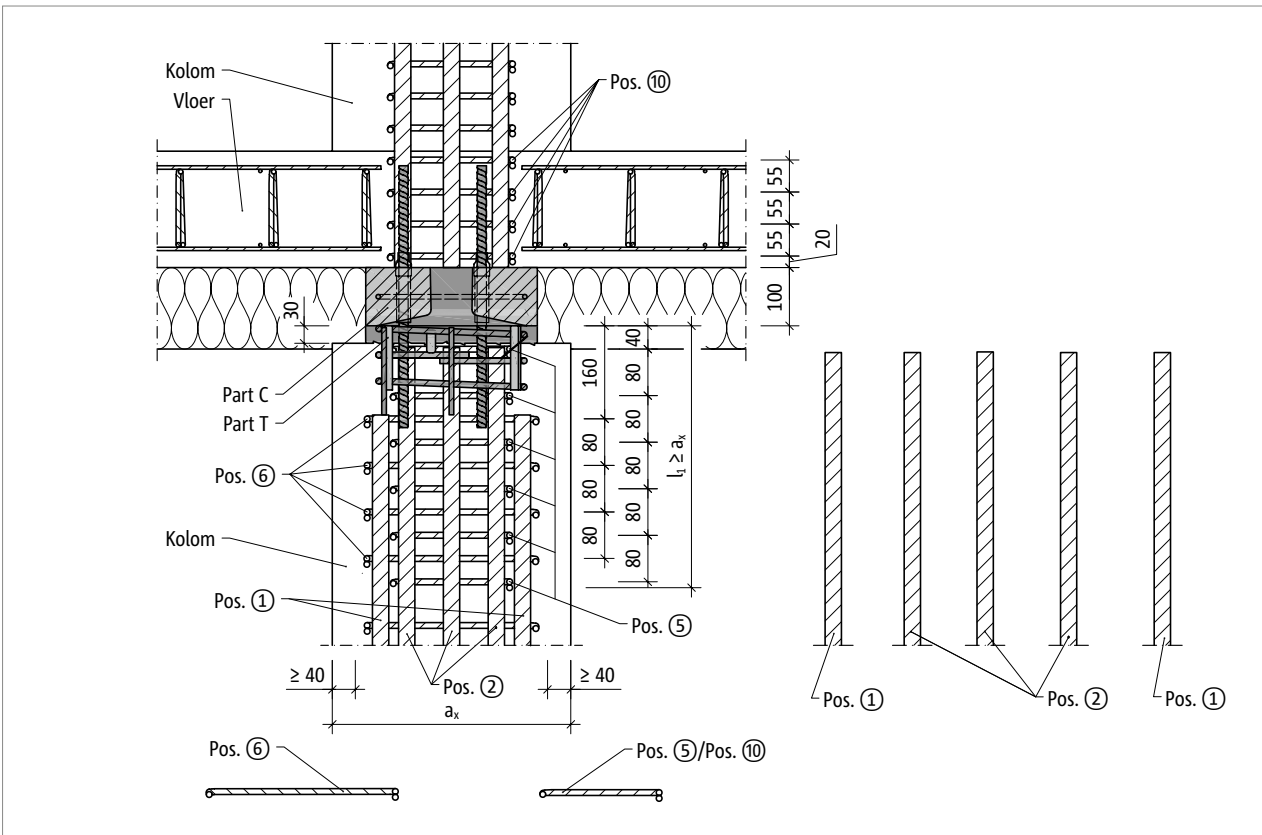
Schöck Sconnex® type P: bijlegwapening in het lengteprofiel van de kolom A-A
